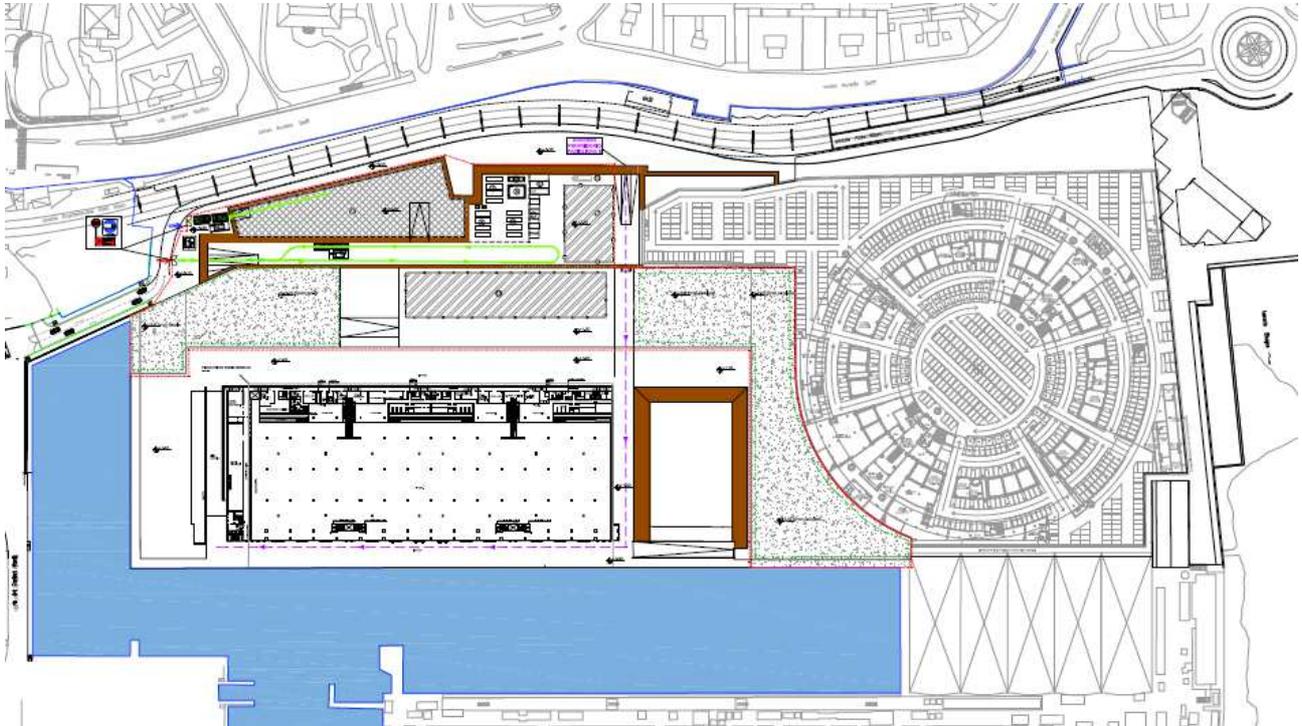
Planimetria di cantiere – Sottofase iniziale
